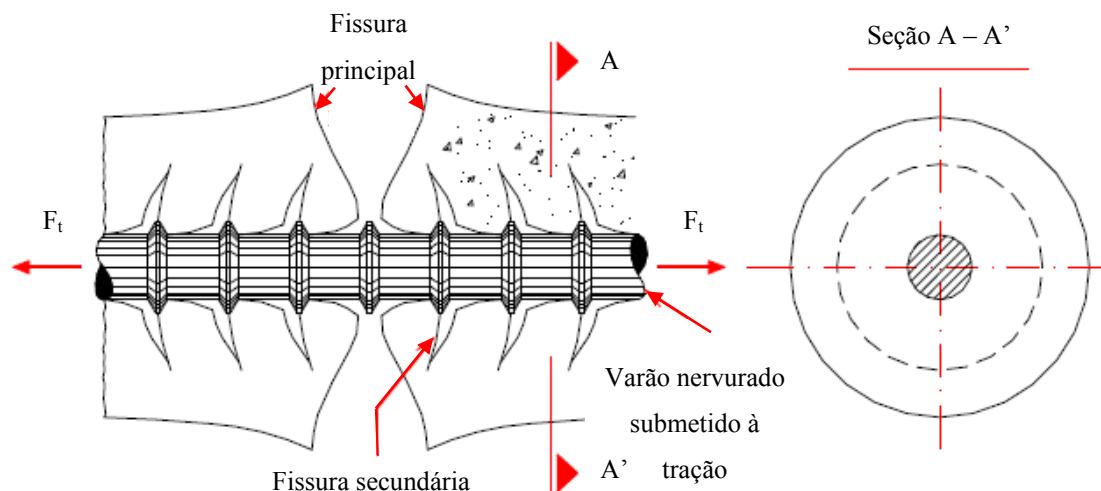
Microfissuras entre fissuras principais, num varão nervurado embebido em betão sob tração centrada - Leonhardt, F. e Monnig, E [30]
